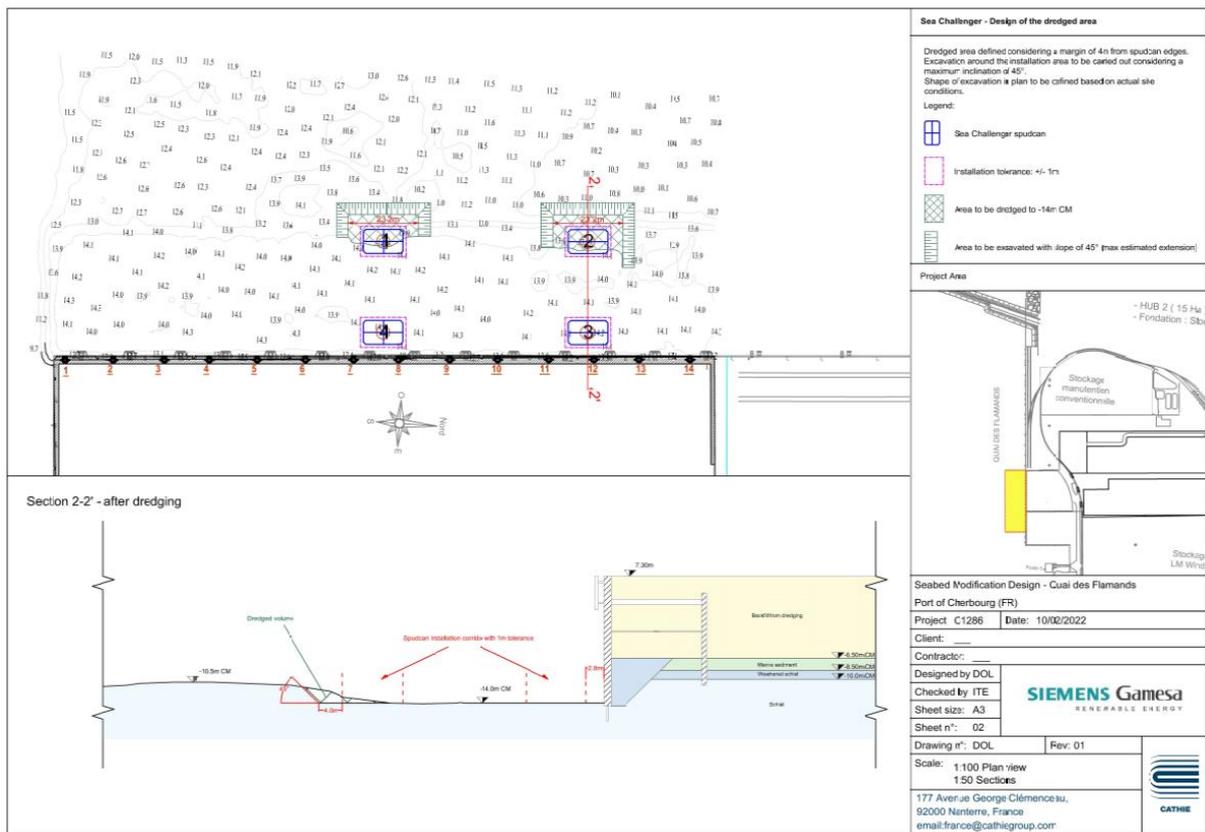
Plan d'implantation et section du plan de dragage réalisé par SGRE (source : SGRE 02/2022)
